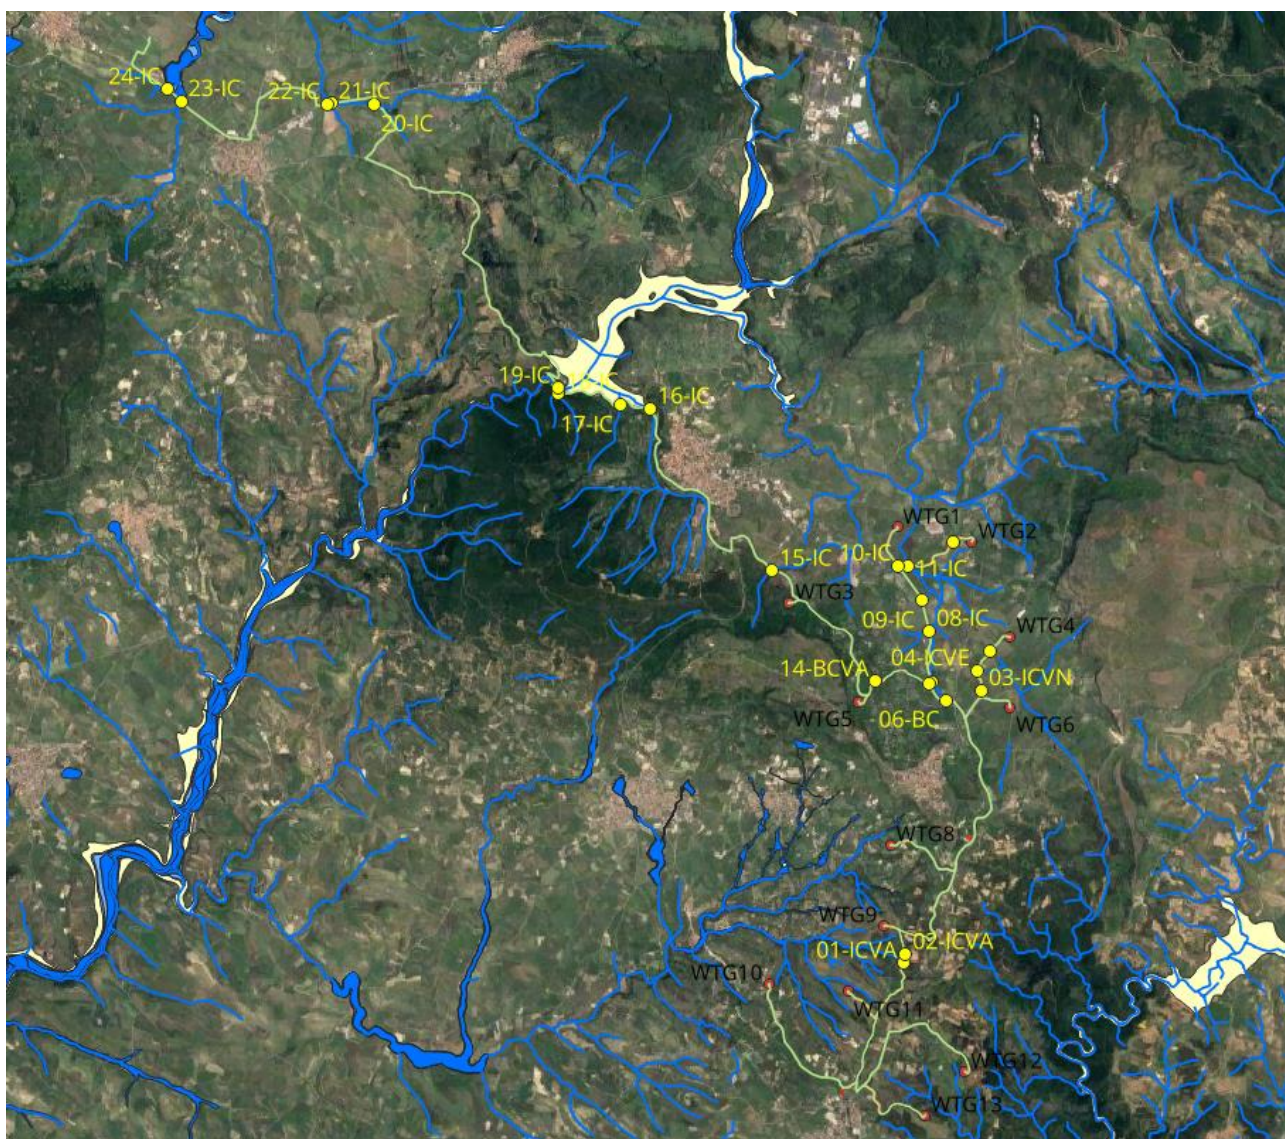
Planimetria interferenze idrauliche cavidotto (colore verde)
